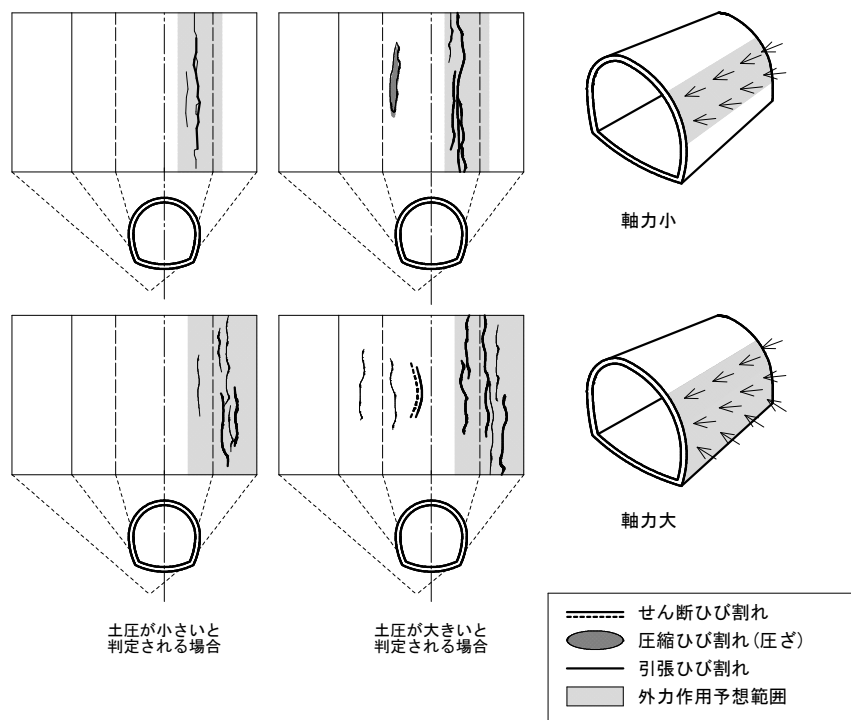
偏圧によるひび割れパターン図
